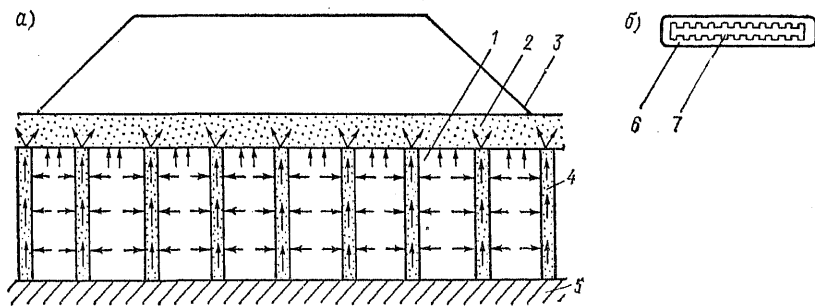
Схема уплотнения слабого грунта статической нагрузкой
